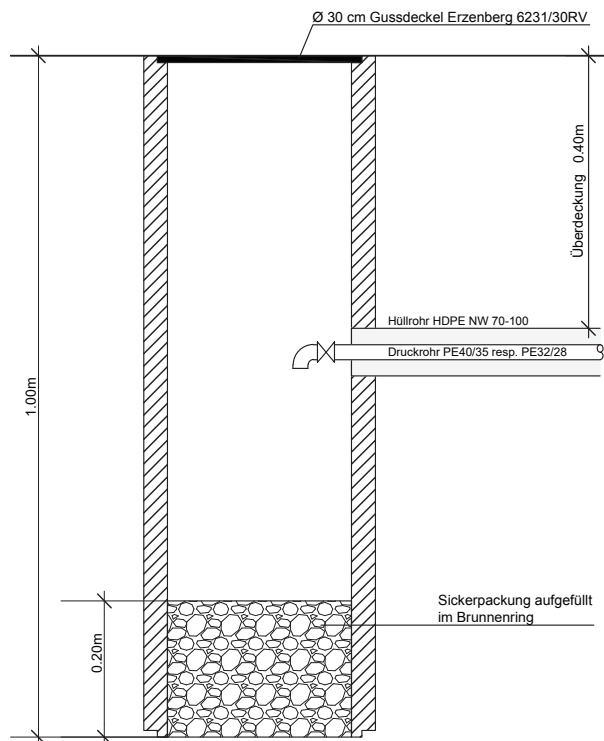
Detail Entleerungsschacht ausserhalb Baumrabatte
